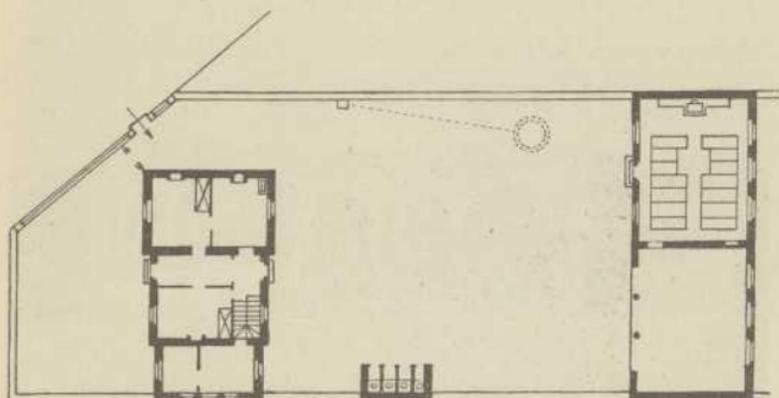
Planta de una escuela rural francesa. Aula, vivienda y retretes en construcciones aisladas
